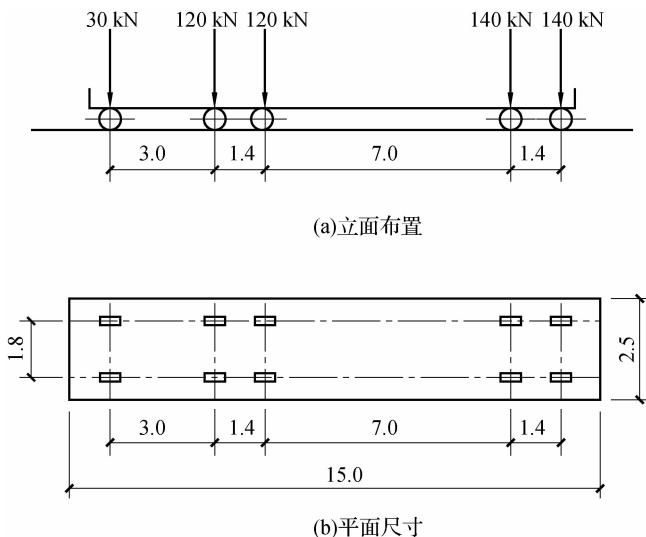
车辆荷载的立面布置及平面尺寸(尺寸单位:m)
